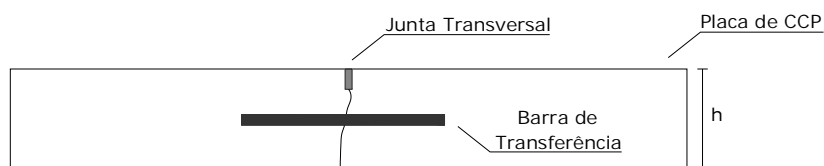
Esquema de junta transversal com barra de transferência de carga.
